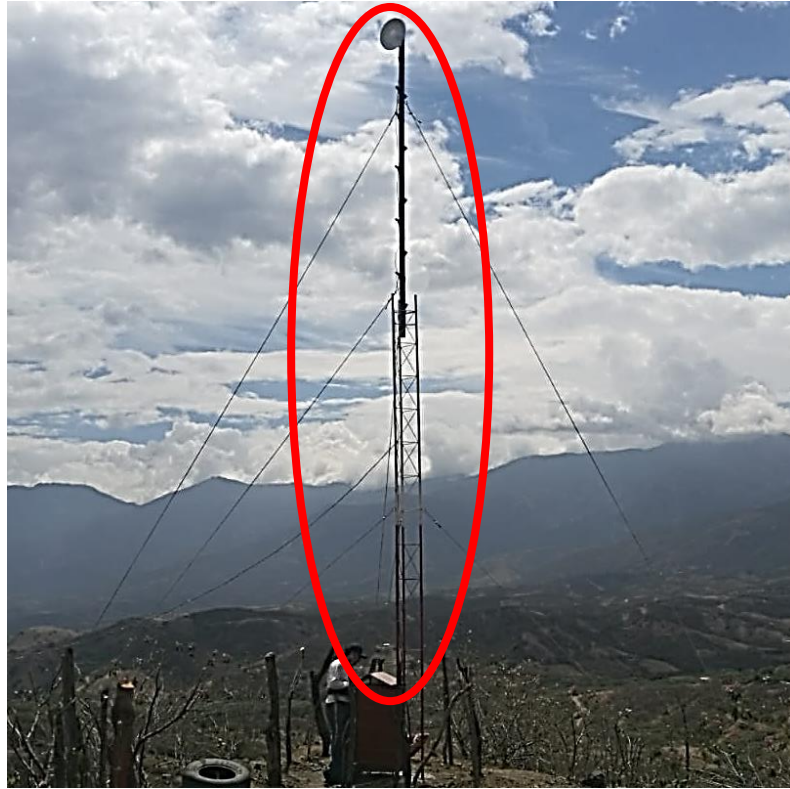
Torre Arriostrada de un Módulo y Tubo Metálico con Escalones
